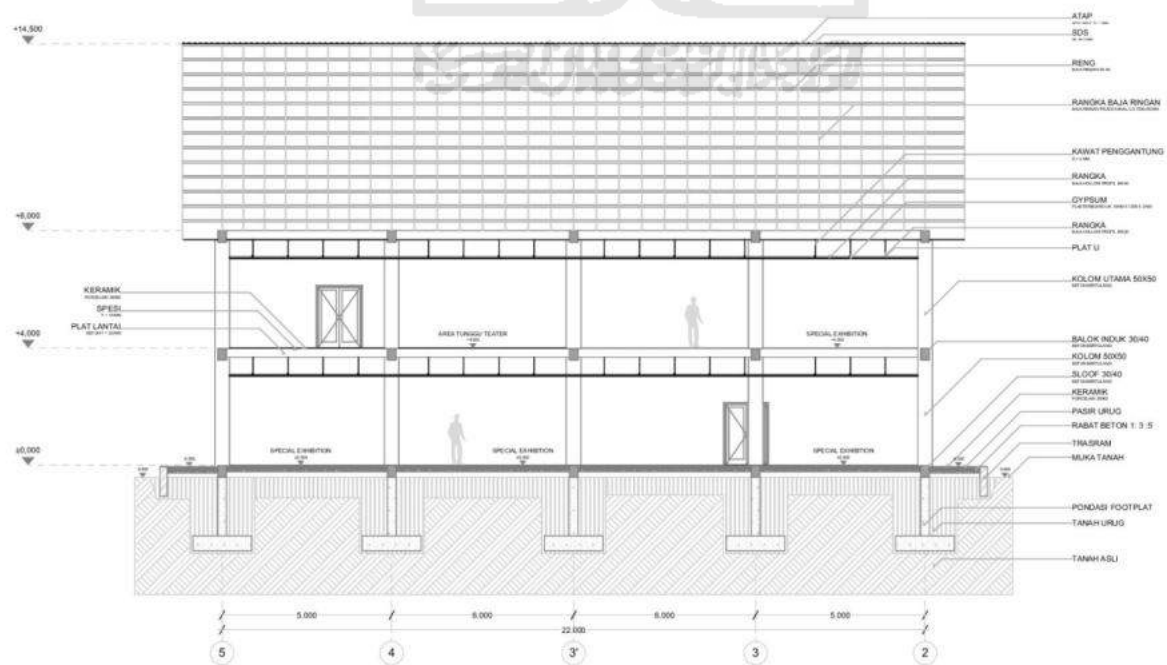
Potongan s-02 bangunan workshop (Sumber: Penulis, 2021)
